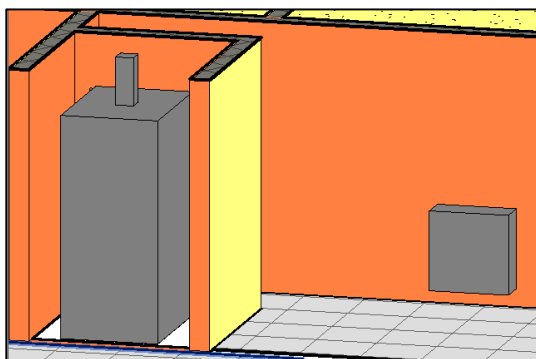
Elevador e cabinas de mangueira para combate de incêndio – Fonte: REVIT
